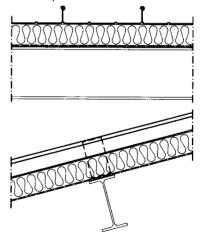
Einschaliges unterseitig wärmegedämmtes Dach mit Falz— bzw. Klemmprofilen
